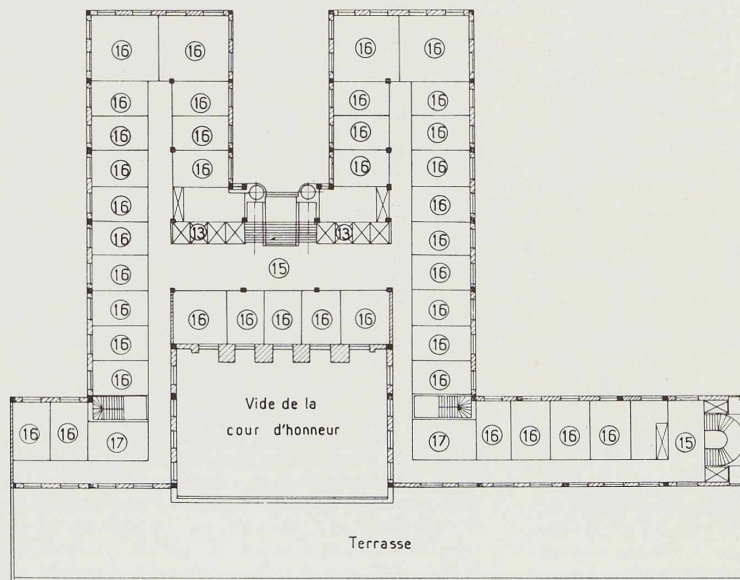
Plan des 4^e, 5^e et 6^e étages :
